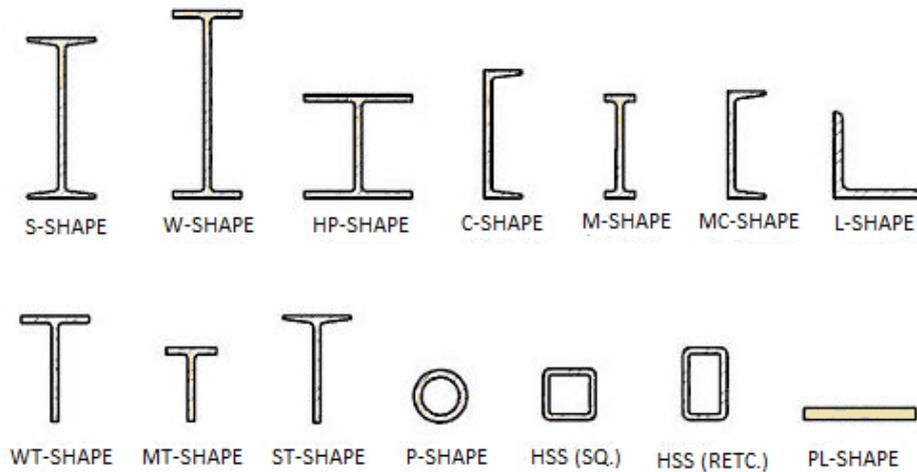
Perfiles de acero estructural. Fuente: Valdivia (2016)
